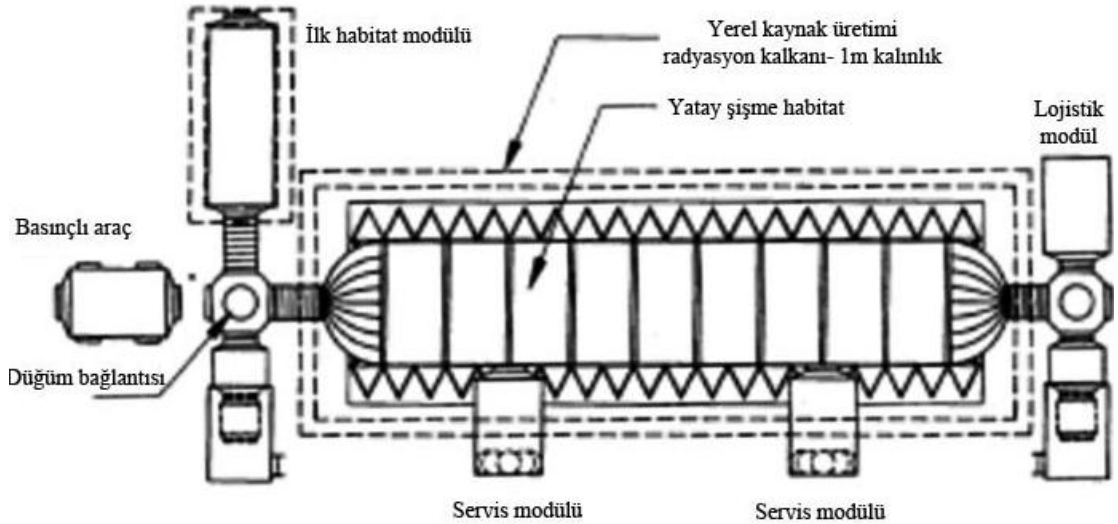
TransHab vaziyet planı (Kronenburg, 2003)
